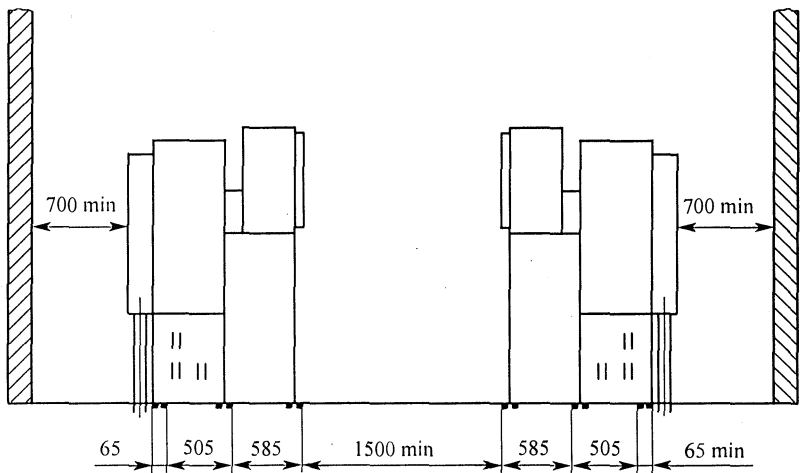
Двухрядное размещение камер К-104М с кабельными вводами снизу камеры
